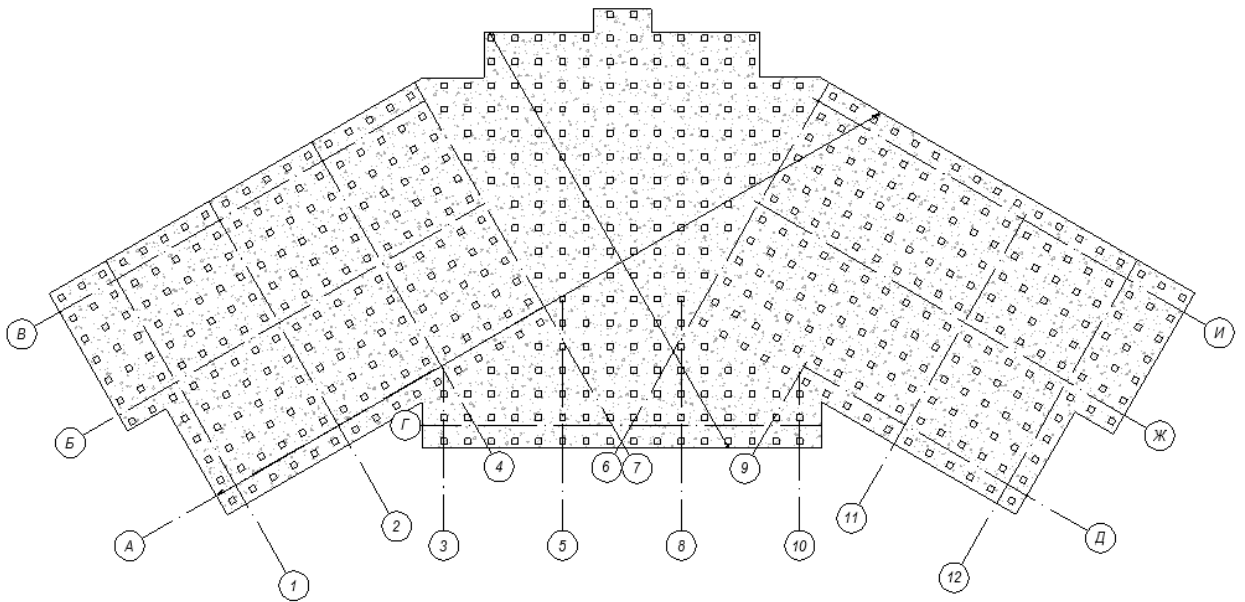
Опалубочный чертеж монолитной плиты фундамента с забивными сваями
